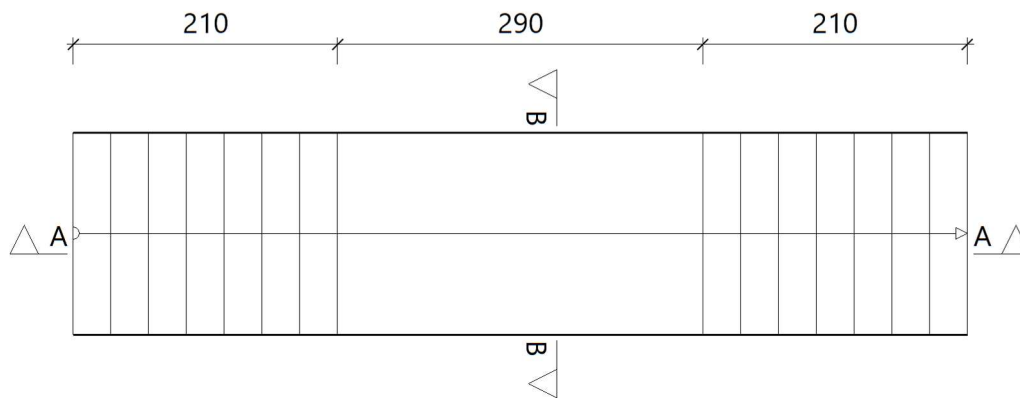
Geometría NUCLEOESC-B3.2 (P1-B3)
